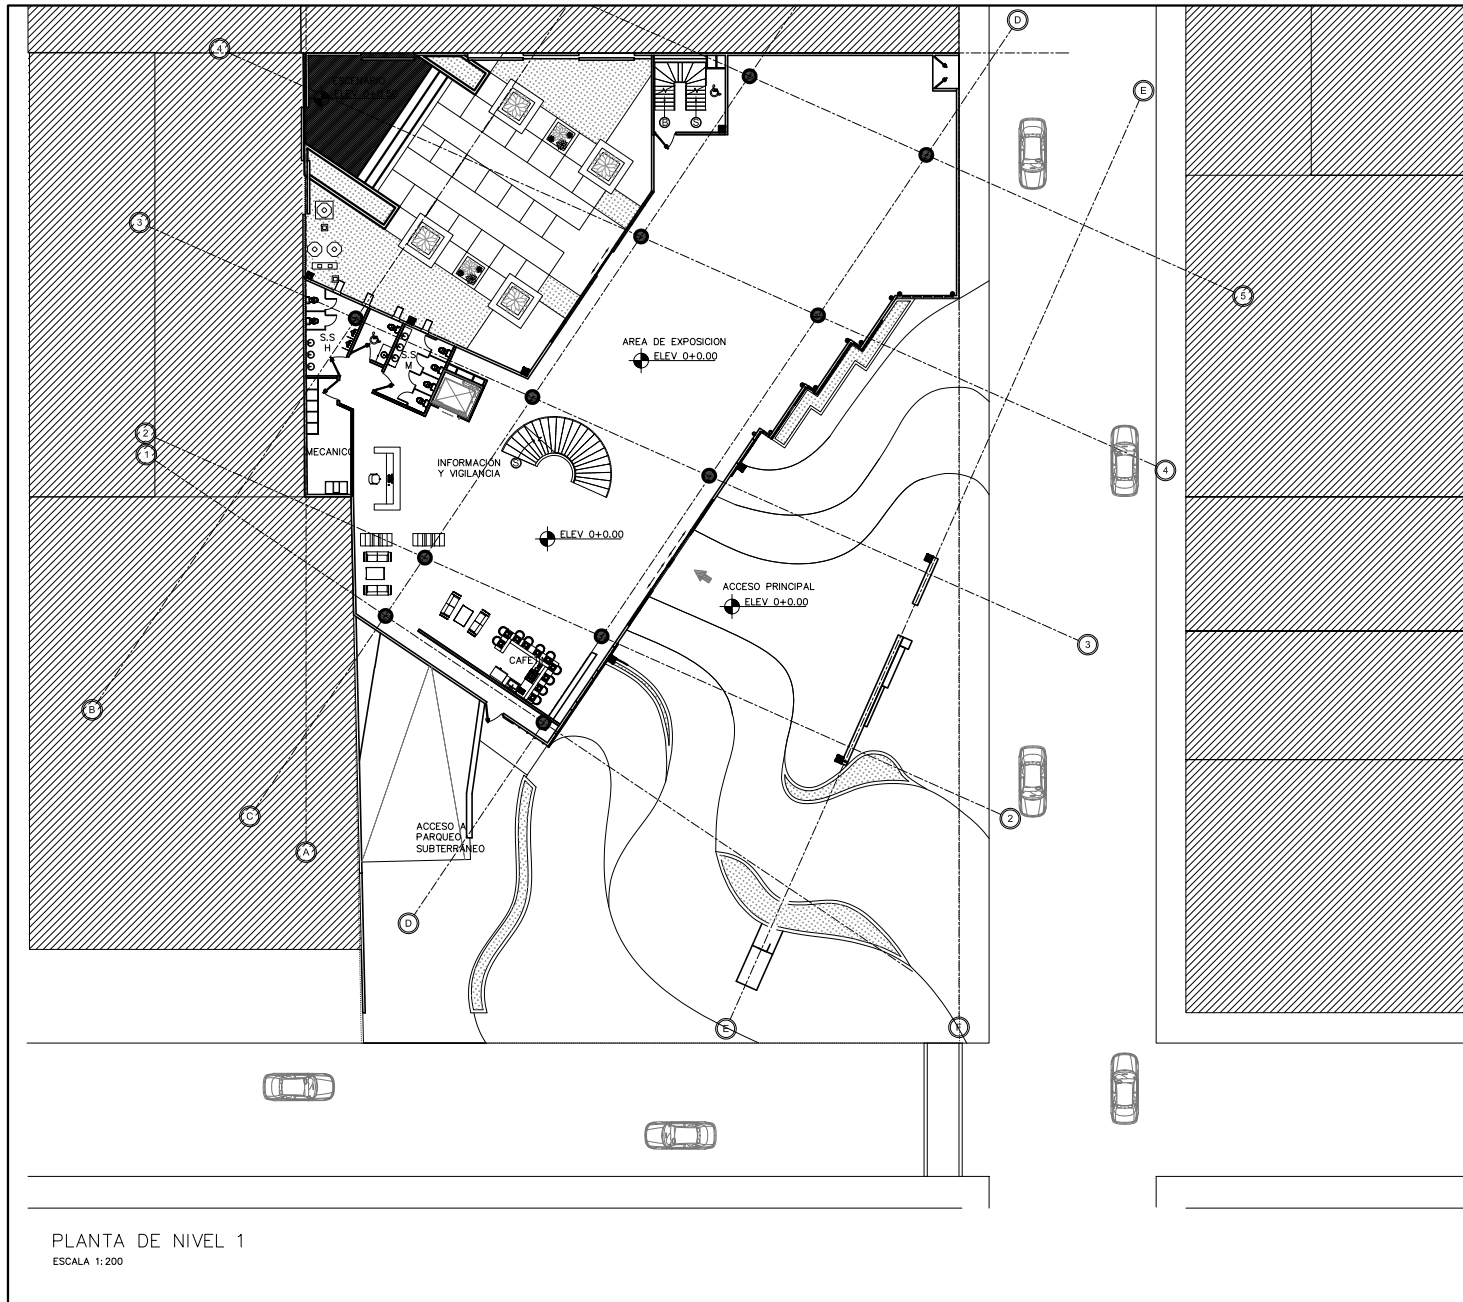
Planta Arquitectónica Nivel I. Fuente: propia
